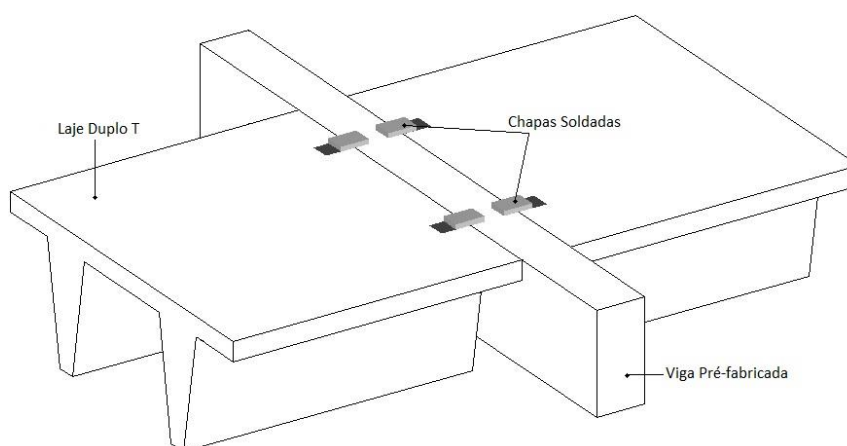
Ligação Laje – Viga central com chapas soldadas
